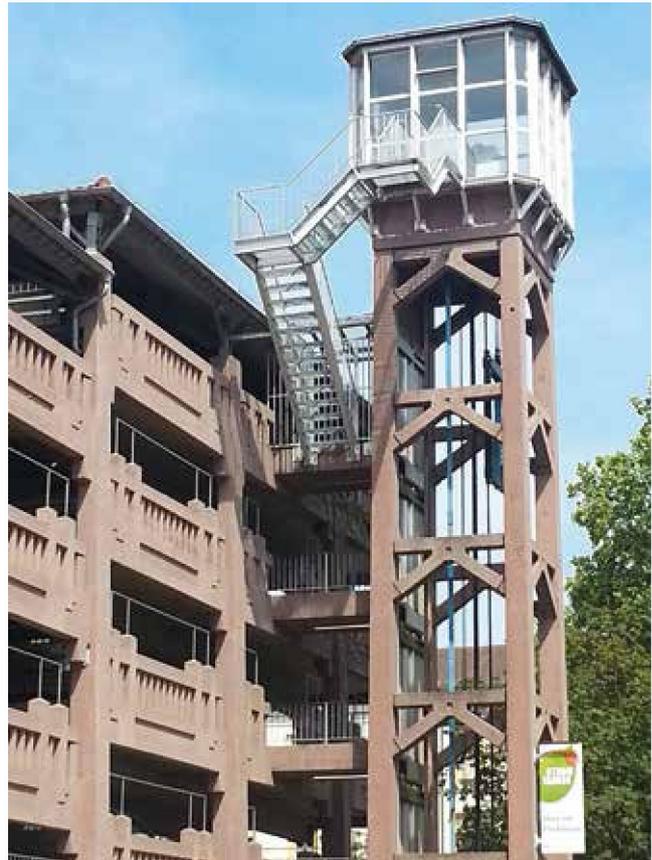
Landau i. d. Pfalz, Parkhaus „Parkpalazzo“
